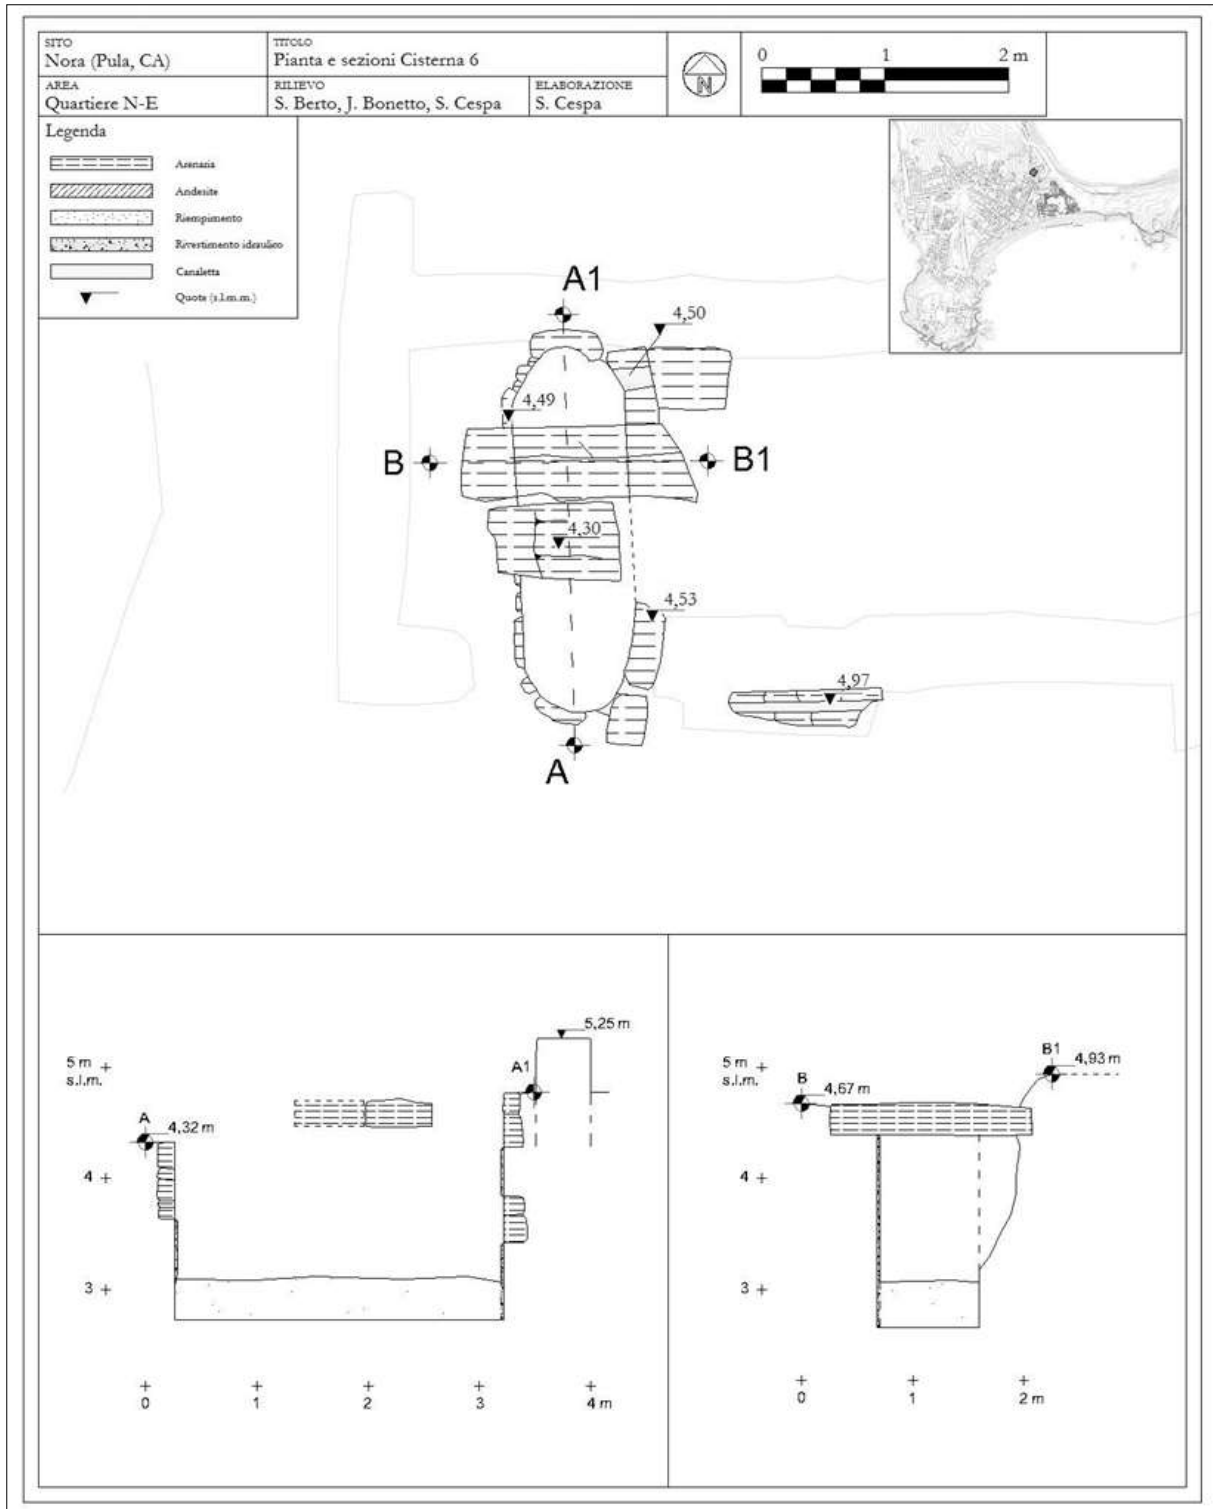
Pianta e sezioni della cisterna 6 (elaborazione dell'autore).
